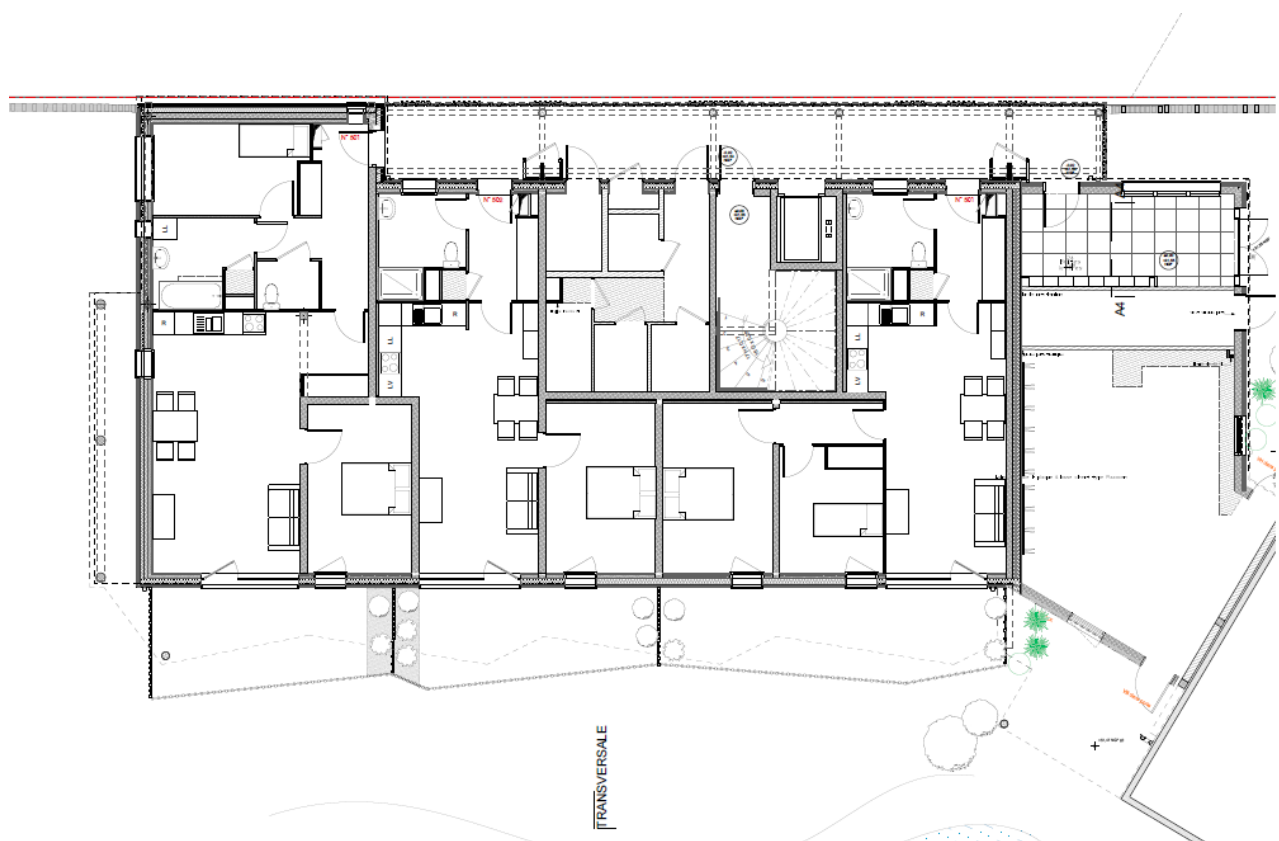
Plan de rez-de-chaussée du cas d'étude (Leroy, 2021)
